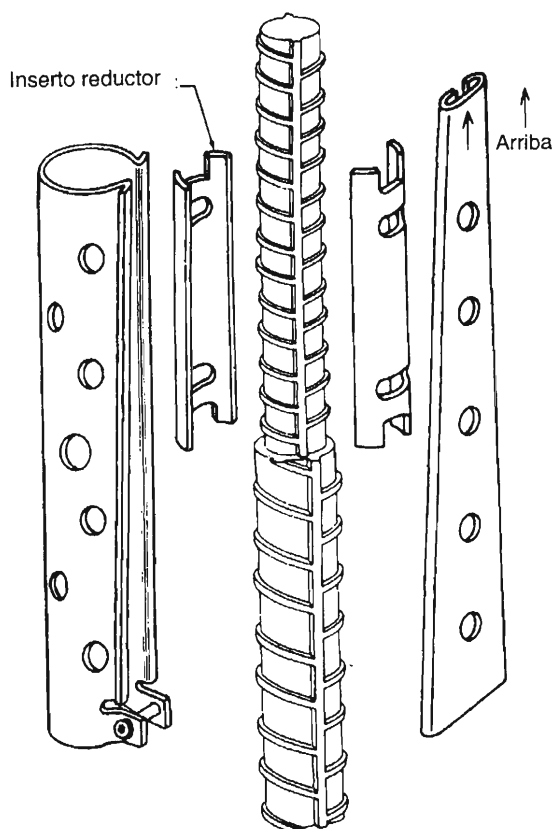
Dispositivo para empalme a tope. (Ref. 24)
